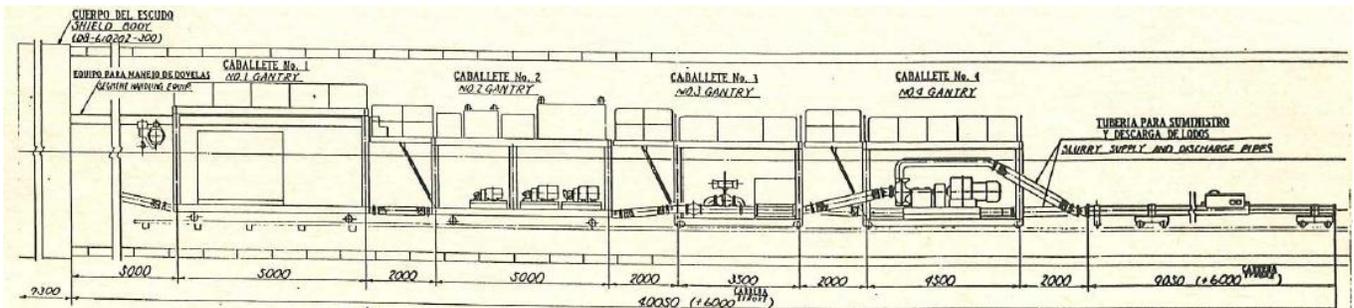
Ejemplo de tren de excavación (o tren de apoyo).
